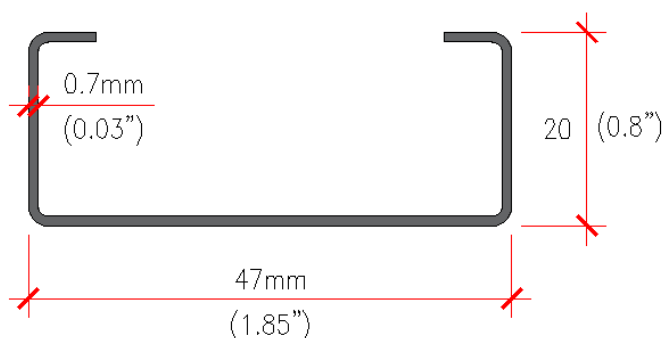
Profil T47 (épaisseur minimale de 0,7 mm)
